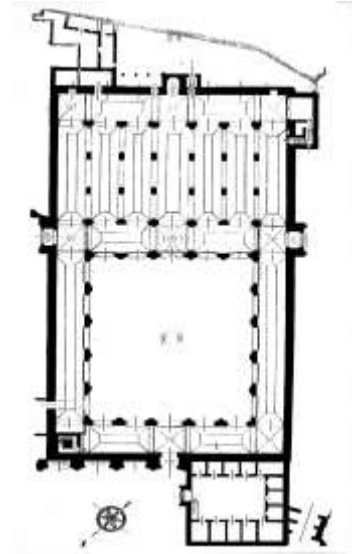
مسقط أفقي للجامع الجديد بتارودانت
